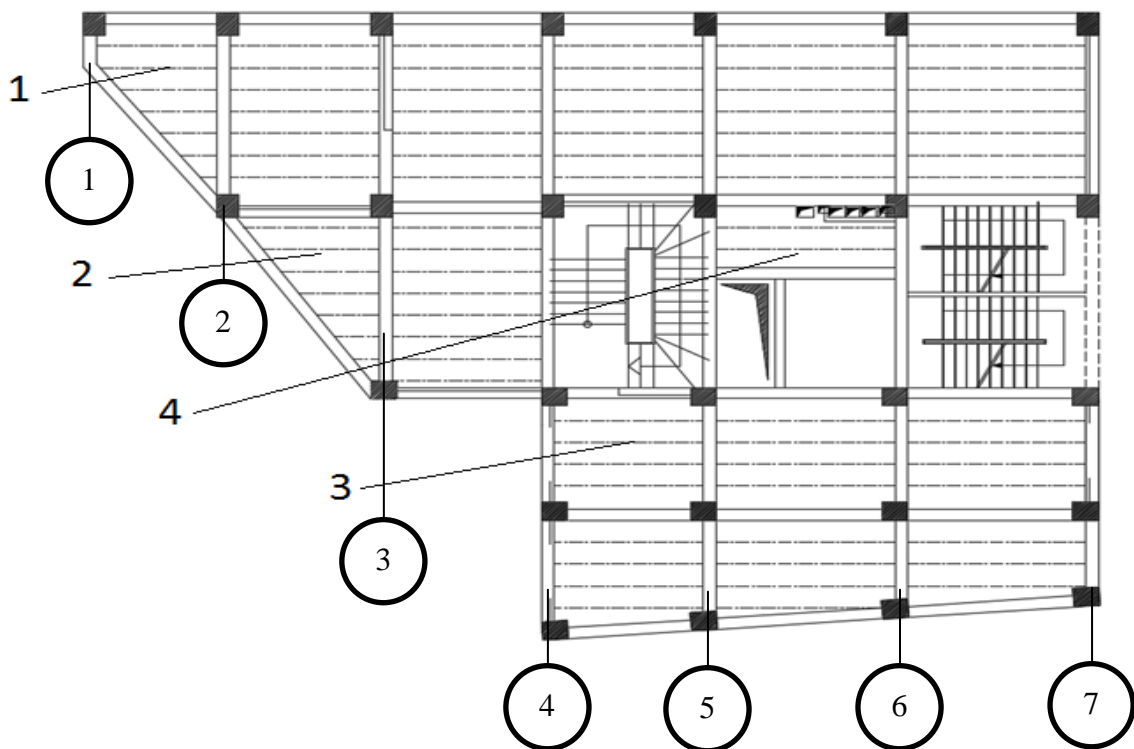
Disposition des poutrelles dans les planchers en corps creux
